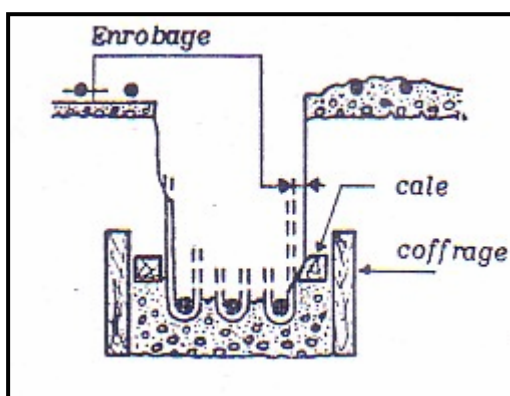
Reconstitution du fond de la poutre et sous face de la dalle [12].
